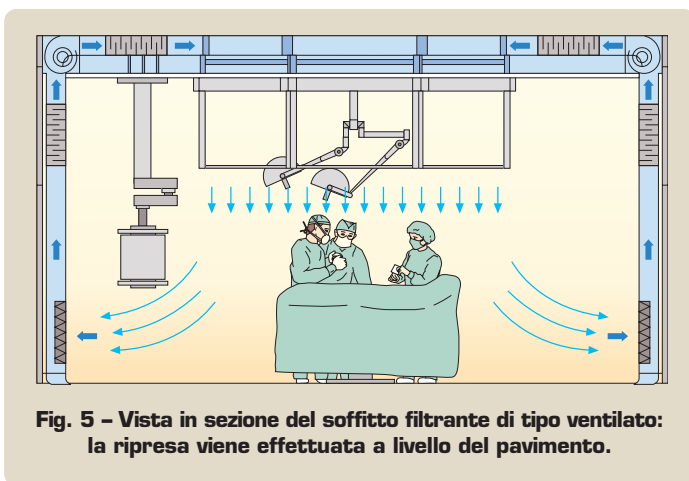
Vista in sezione del soffitto filtrante di tipo ventilato: la ripresa viene effettuata a livello del pavimento.
